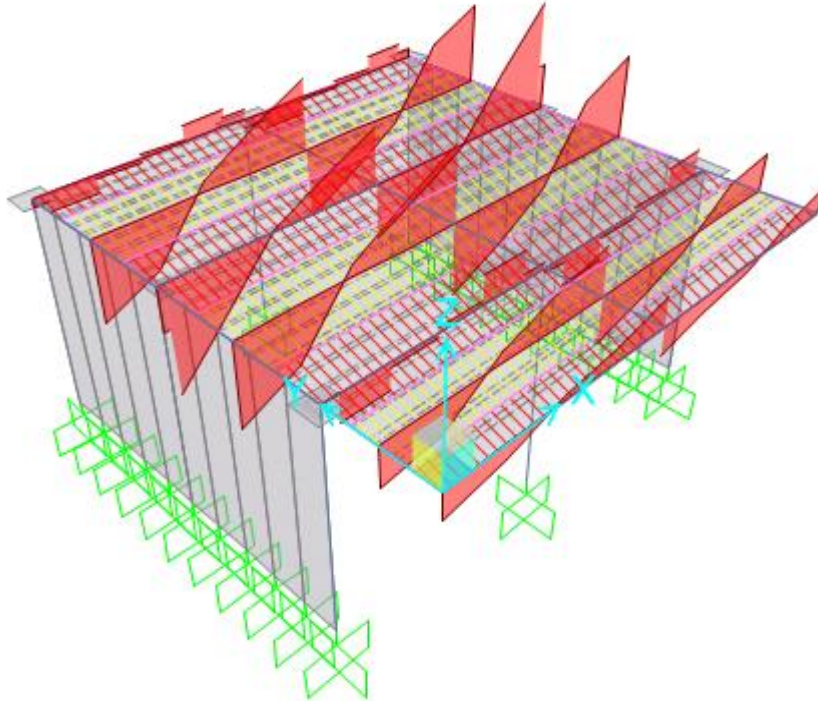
Fuerza Cortante en las Viguetas de la losa aligerada del módulo de Aulas-Bloque H-I.
